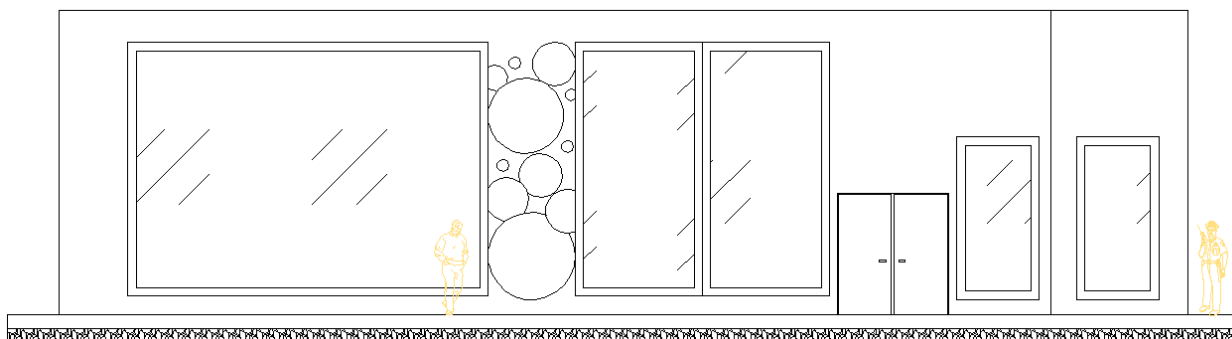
Fachada Frontal Cancha Deportiva
